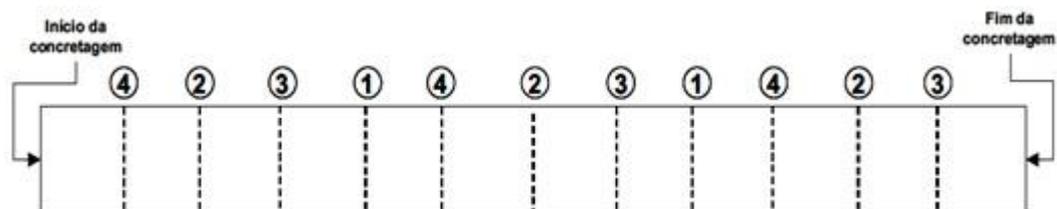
Plano de corte de juntas transversais – sequência de corte
